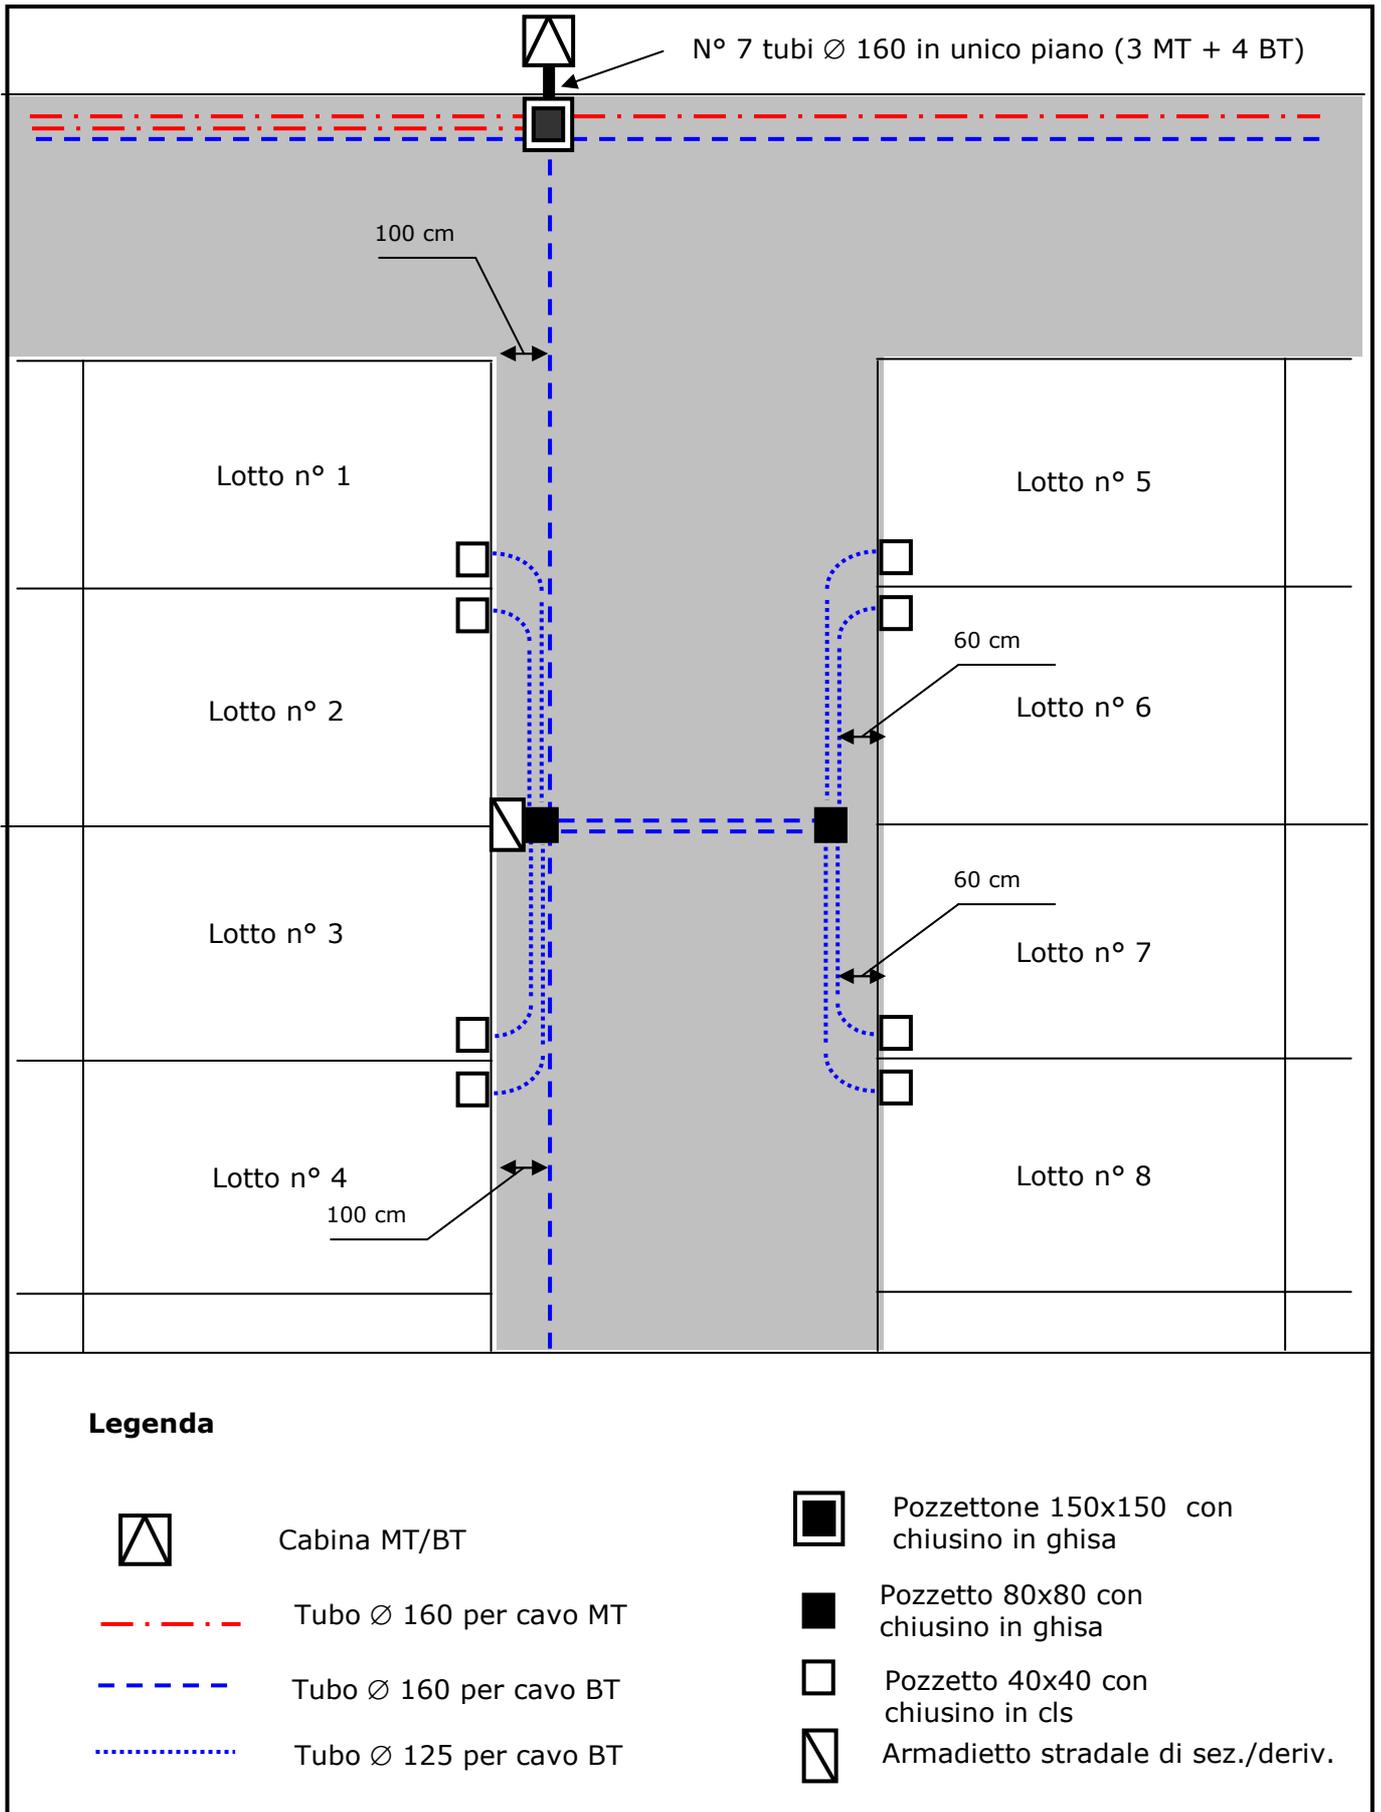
Esempio di planimetria da restituire a Enel Distribuzione.
